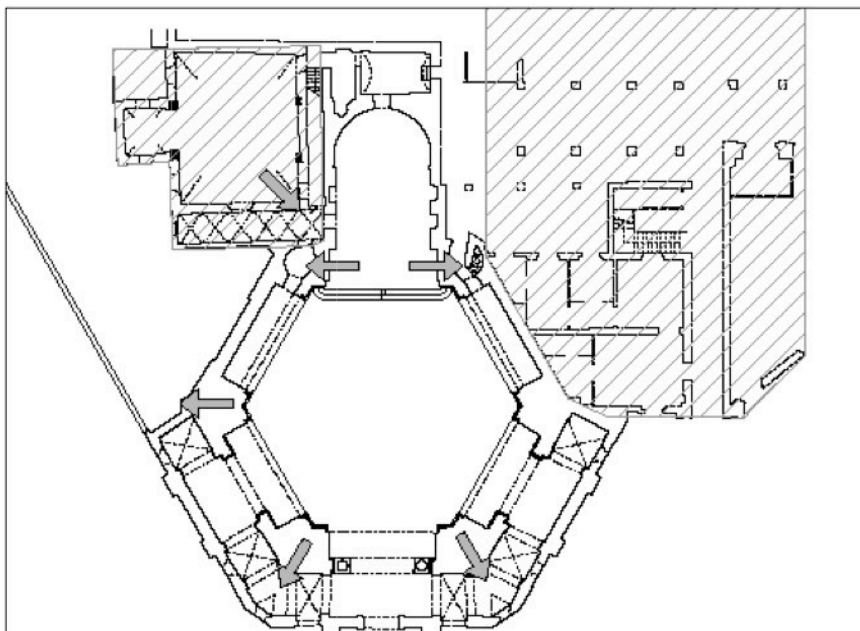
Planimetria del complesso con indicazione del nuovo edificio accostato
